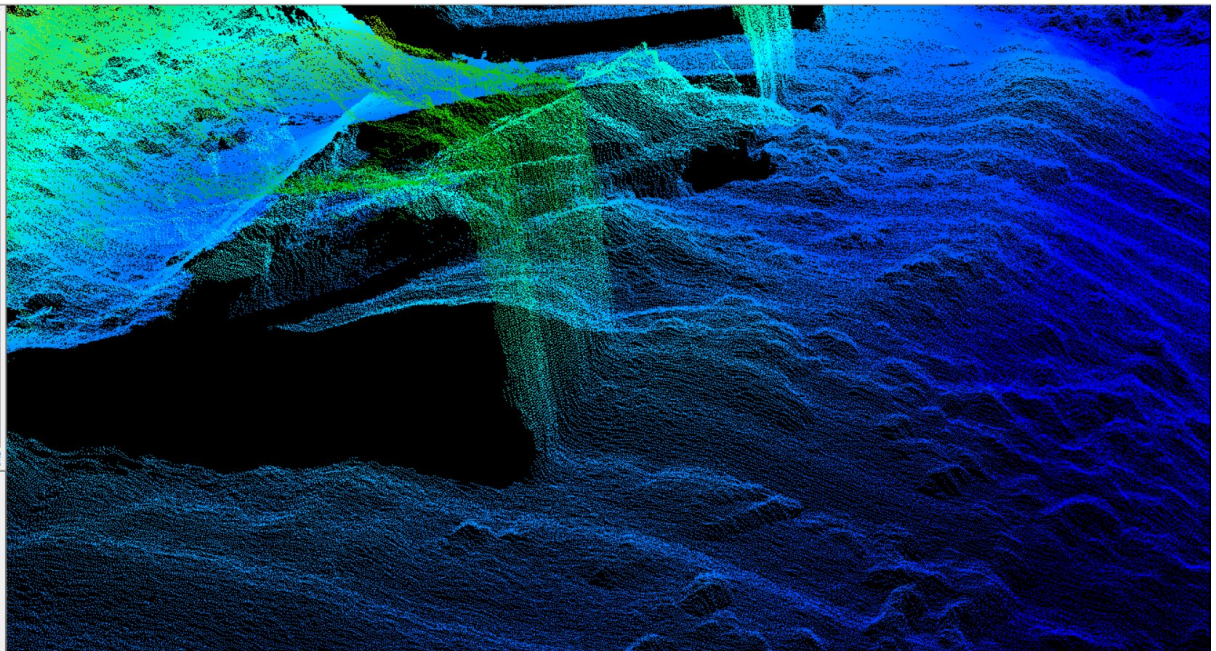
Cimentación y banqueta pila P6 y restos caídos del vano P5-P6.
